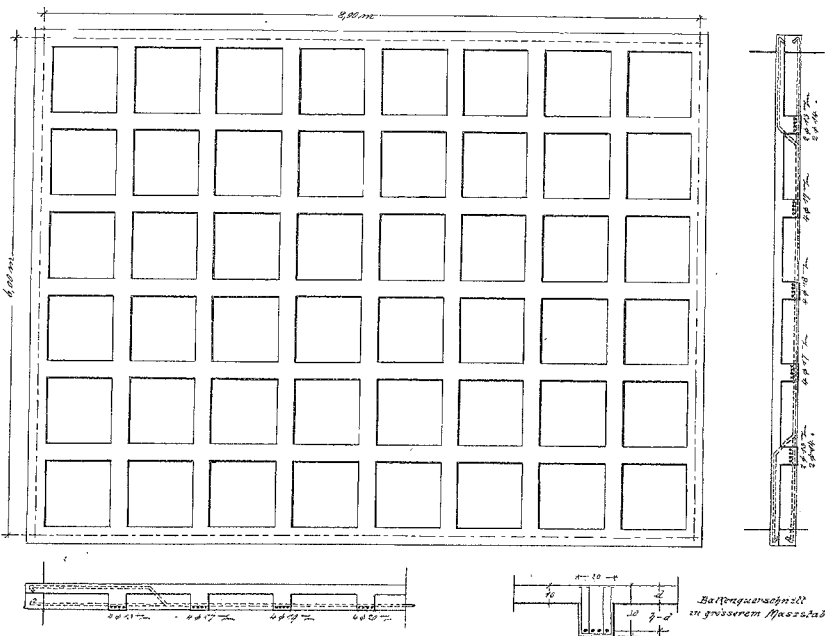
Grundriss und Querschnitt einer Kassetendecke.
